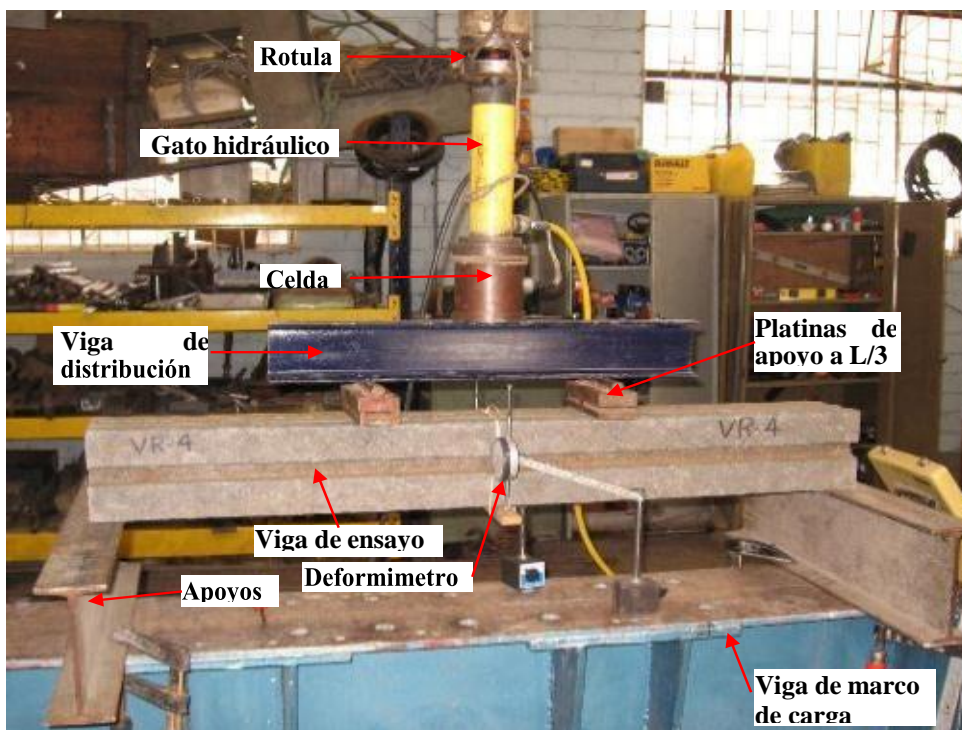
Montaje de ensayo a flexión típico en viga de cimentación.
